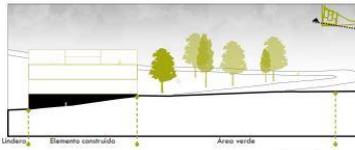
Corte longitudinal del área construida y no construida. (Autor)
